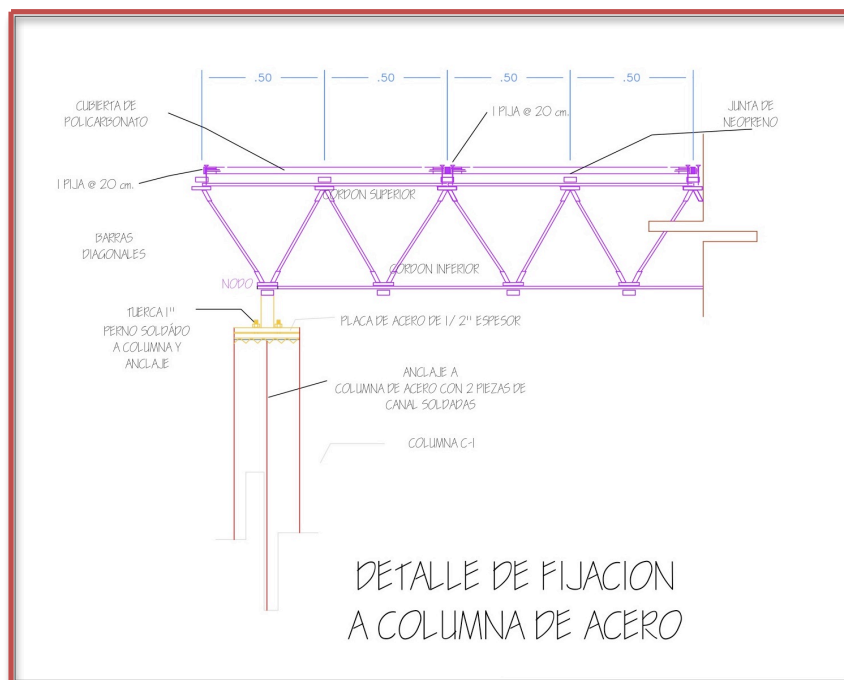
Detalle de anclaje de tridilosa a columna, propuesta por Juan Ramírez.
